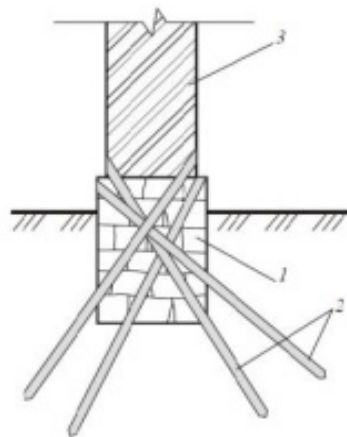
Усиление фундаментов буроинъекционными сваями: 1-фундамент, 2-буроинъекционные сваи, 3-стена.
